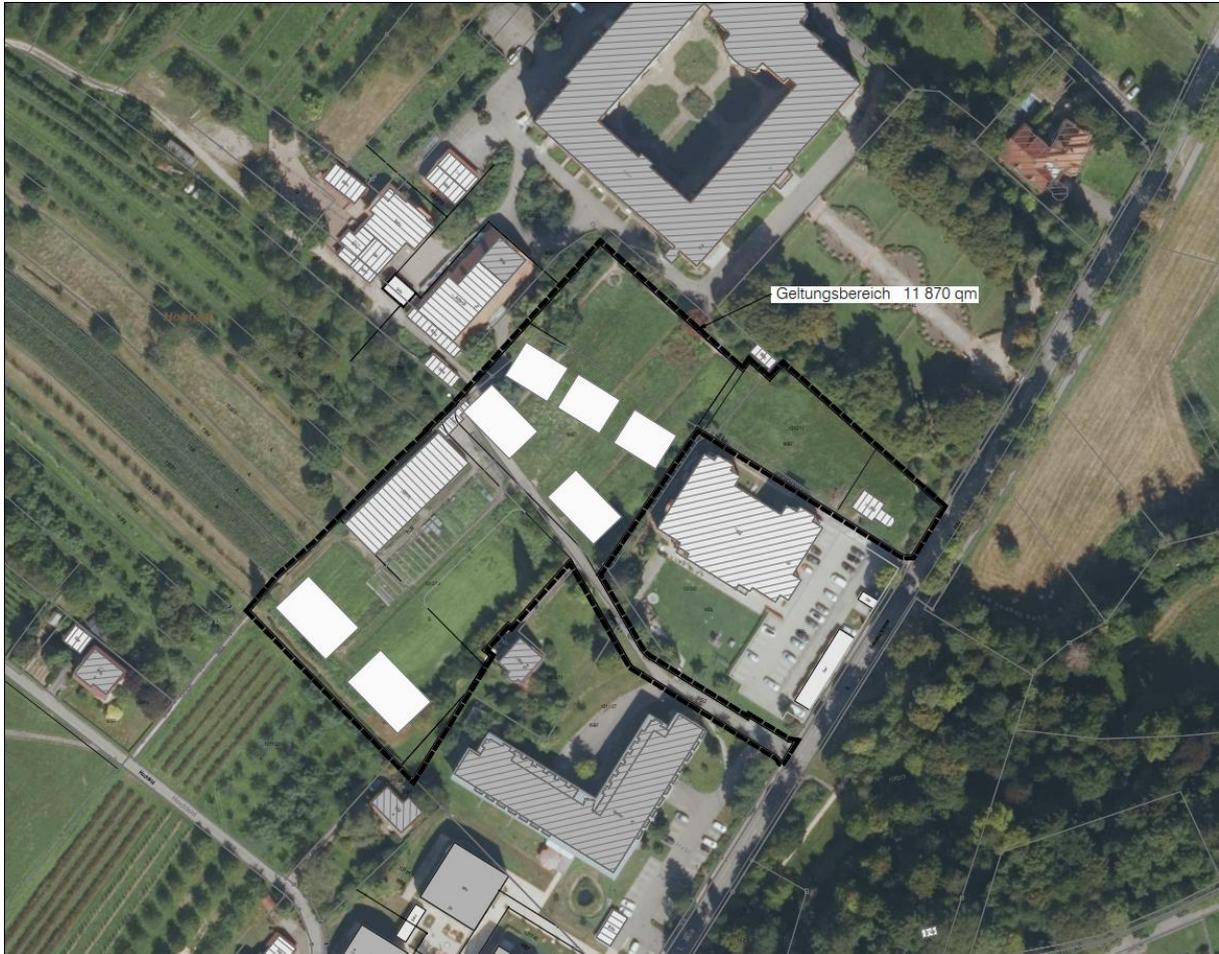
Baukonzept für das Plangebiet „Klostergarten“; Quelle: Zink Ingenieure, Juli 2024
